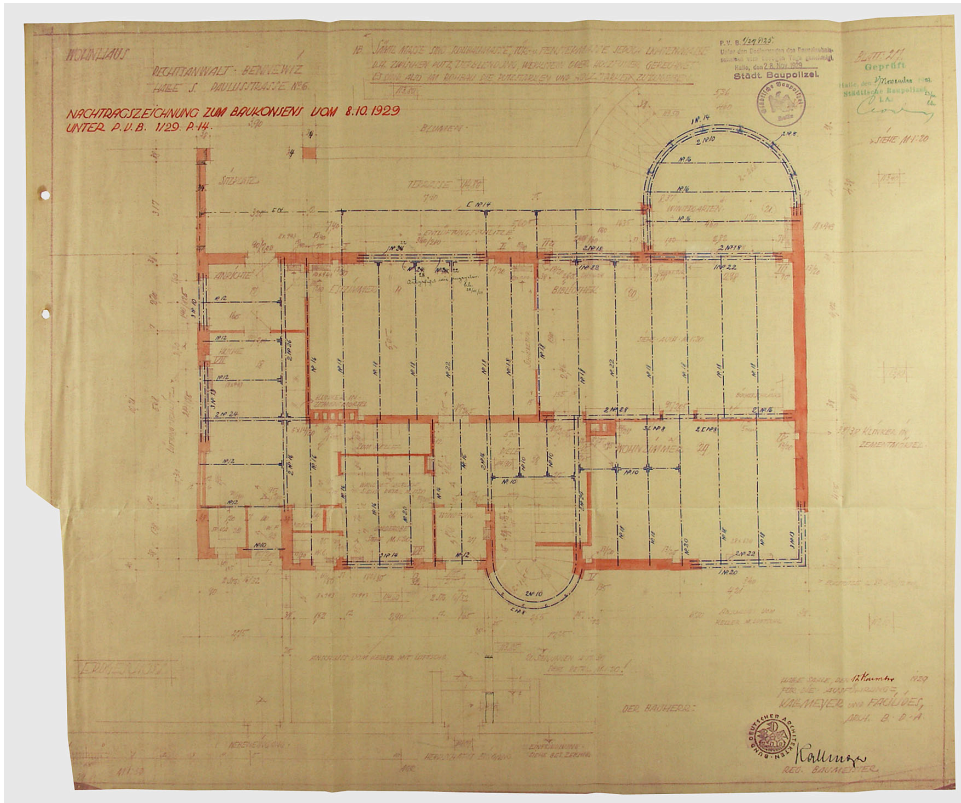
Wohnhaus in der Heinrich-Heine-Straße 6 in Halle, Grundriss Erdgeschoss, datiert 12. November 1929.
